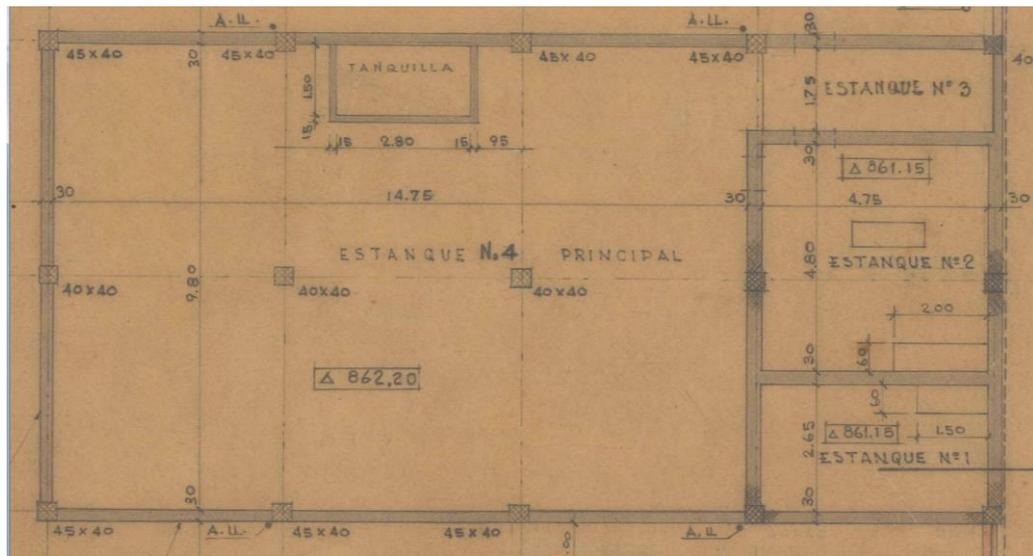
Detalle de los muros estructurales en la planta baja del edificio.
